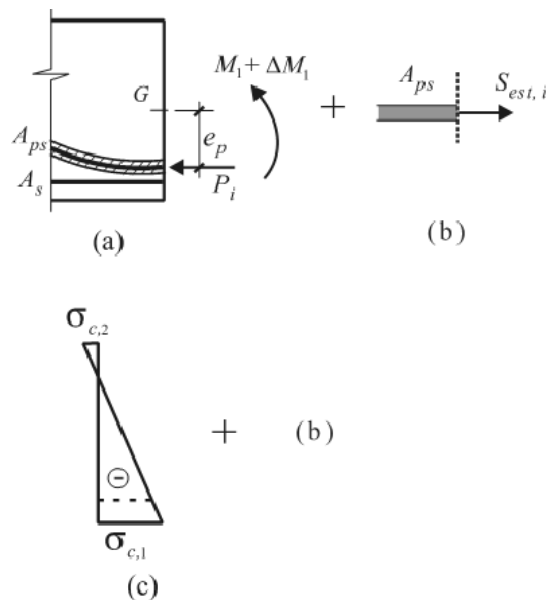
Modelo para la representación del estado de tensión normal sobre el concreto y las armaduras (pasiva y activa) en las condición correspondiente al pretensado y posterior inyección del conducto con lechada de cemento. (a) Sección sometida a P_i excéntrico más el momento flector M_1 (correspondiente a la peso propio del elemento con conducto no inyectado) + ΔM_1 (correspondiente a la inyección del conducto); (b) Aislamiento del esfuerzo de tracción previo, $S_{est,i}$, presente en la armadura activa; (c) Tensión normal sobre el concreto.
